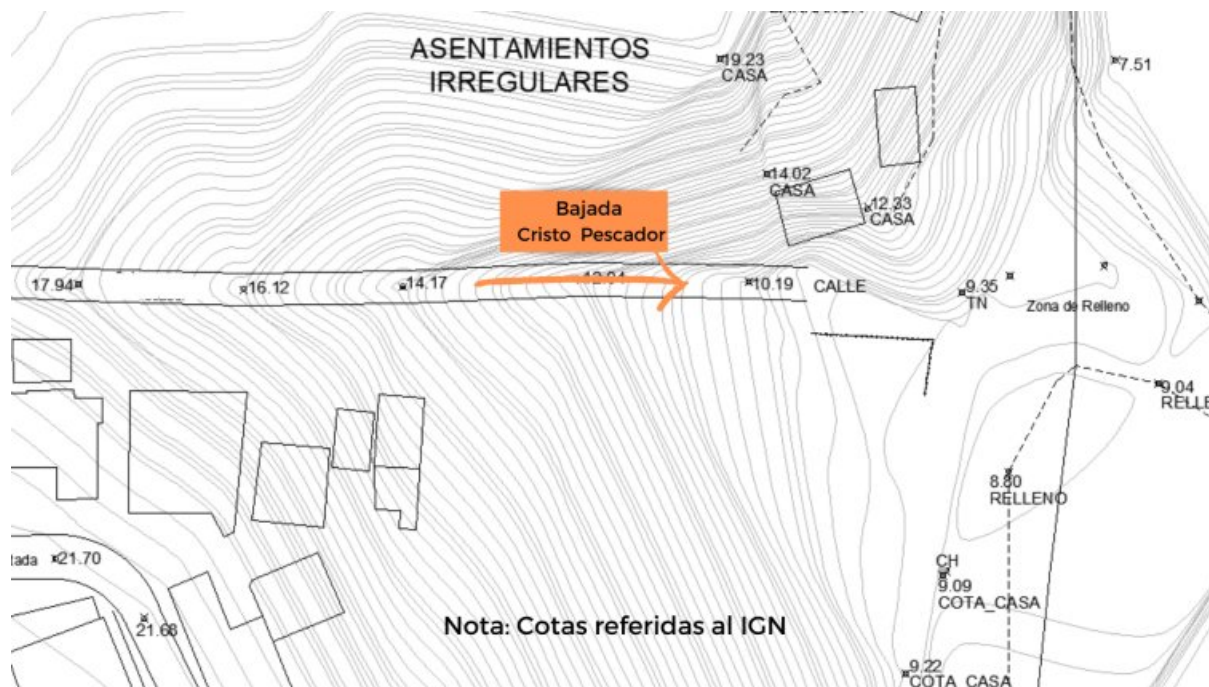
Porción de planialtimetría en donde se muestra la Bajada Cristo Pescador -
